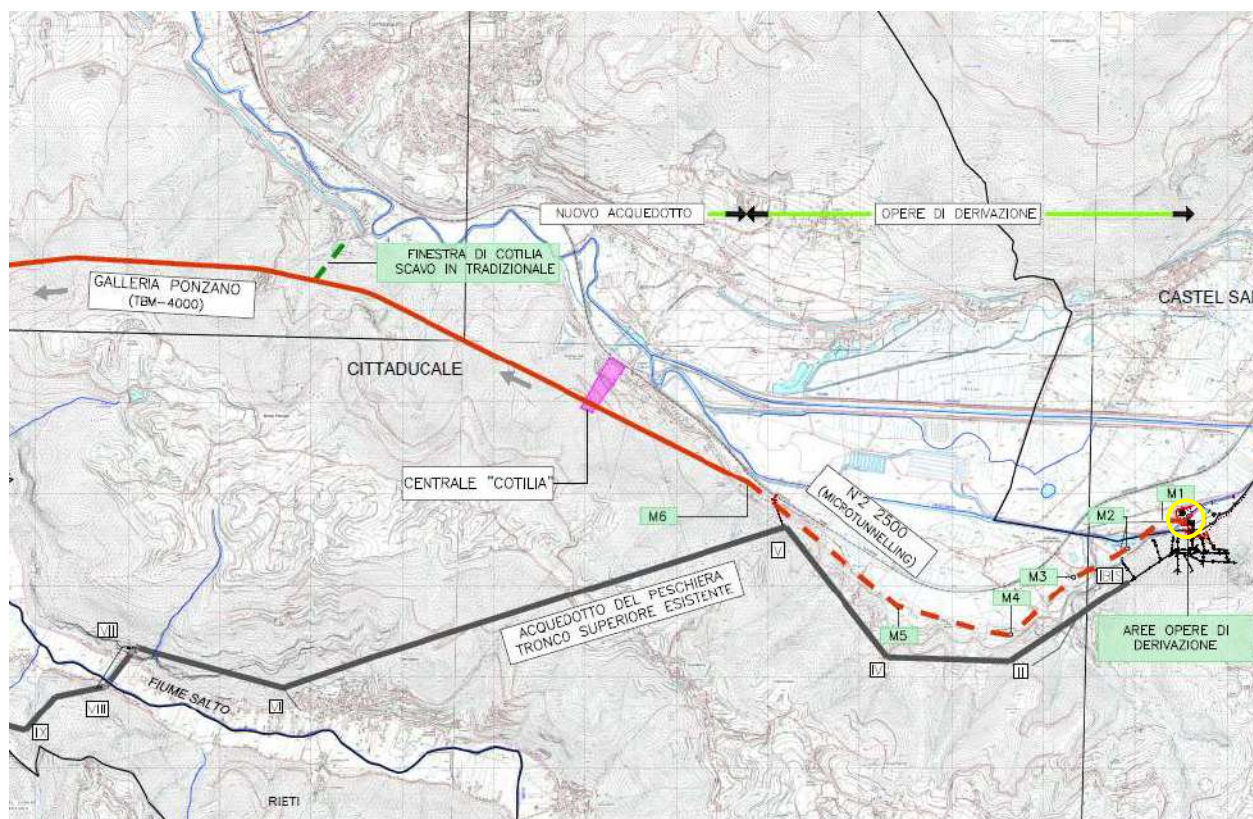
Ubicazione del Manufatto di Origine Canale– vista planimetrica
